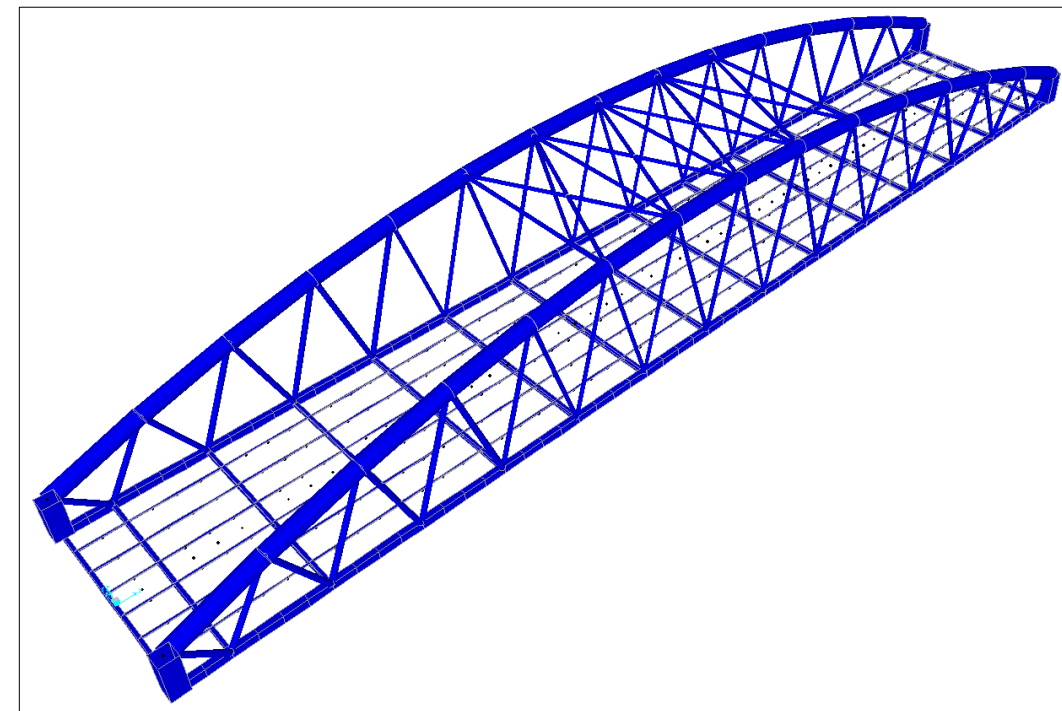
Vista 3d modelo Sap2000, vista sin las placas de hormigón (Fuente: elaboración propia)
